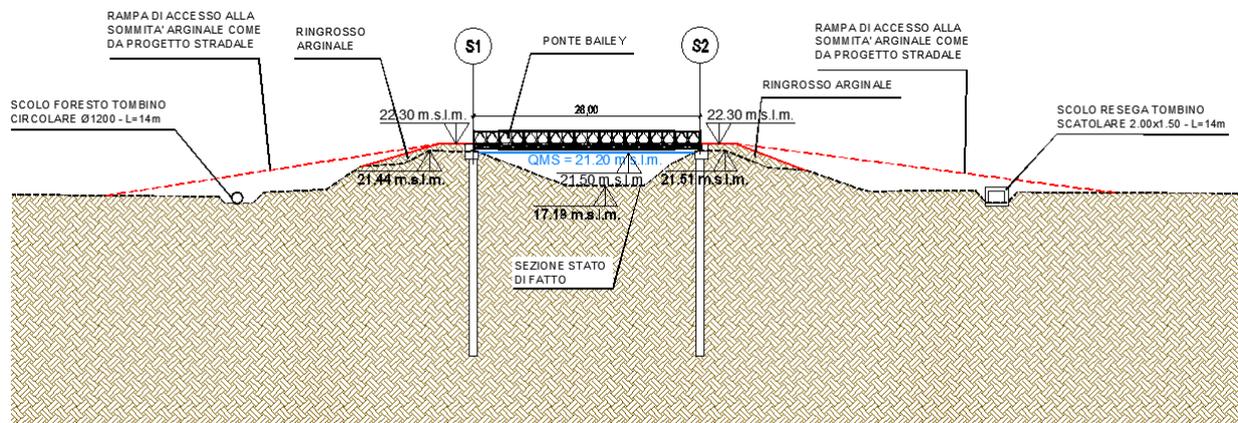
SEZIONE LONGITUDINALE CON UBICAZIONE DEL PONTE "BAILEY" IN CORRISPONDENZA DEL CANALE FOSSA RASO
